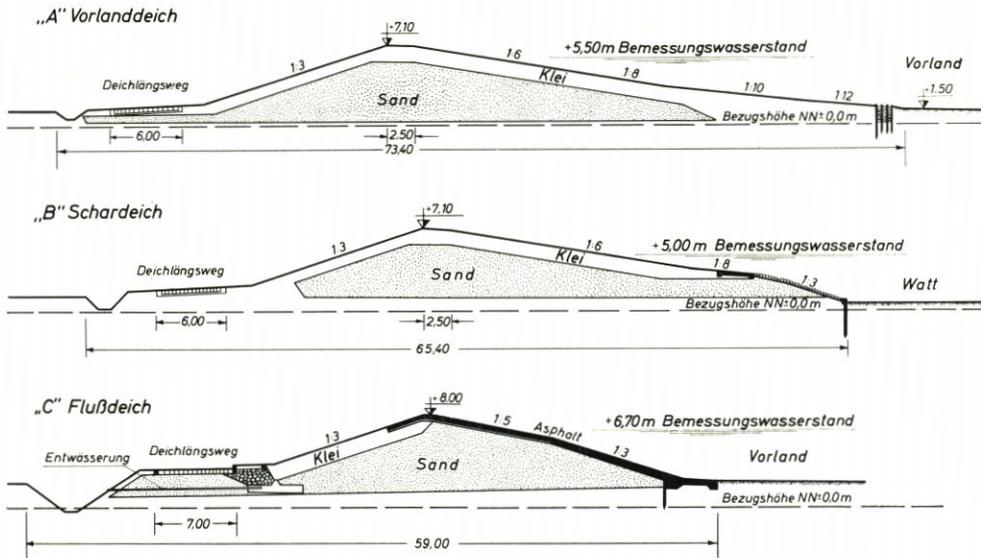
Querschnitt von Deichen mit Sandkern und einer Klei- oder Asphaltdecke
